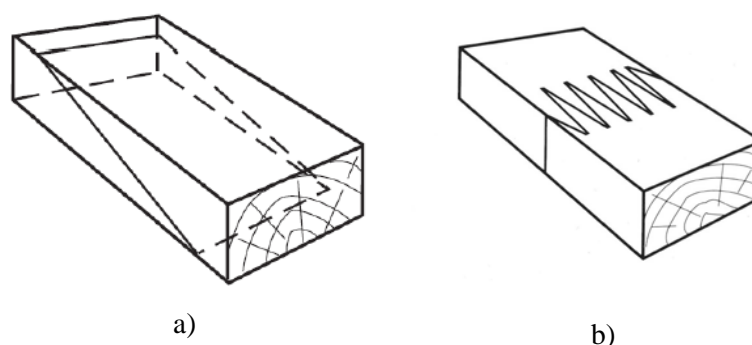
Ligações coladas: a) Ligação entre 2 painéis (scarf joint); b) Ligação dentada (finger joint) [36].
